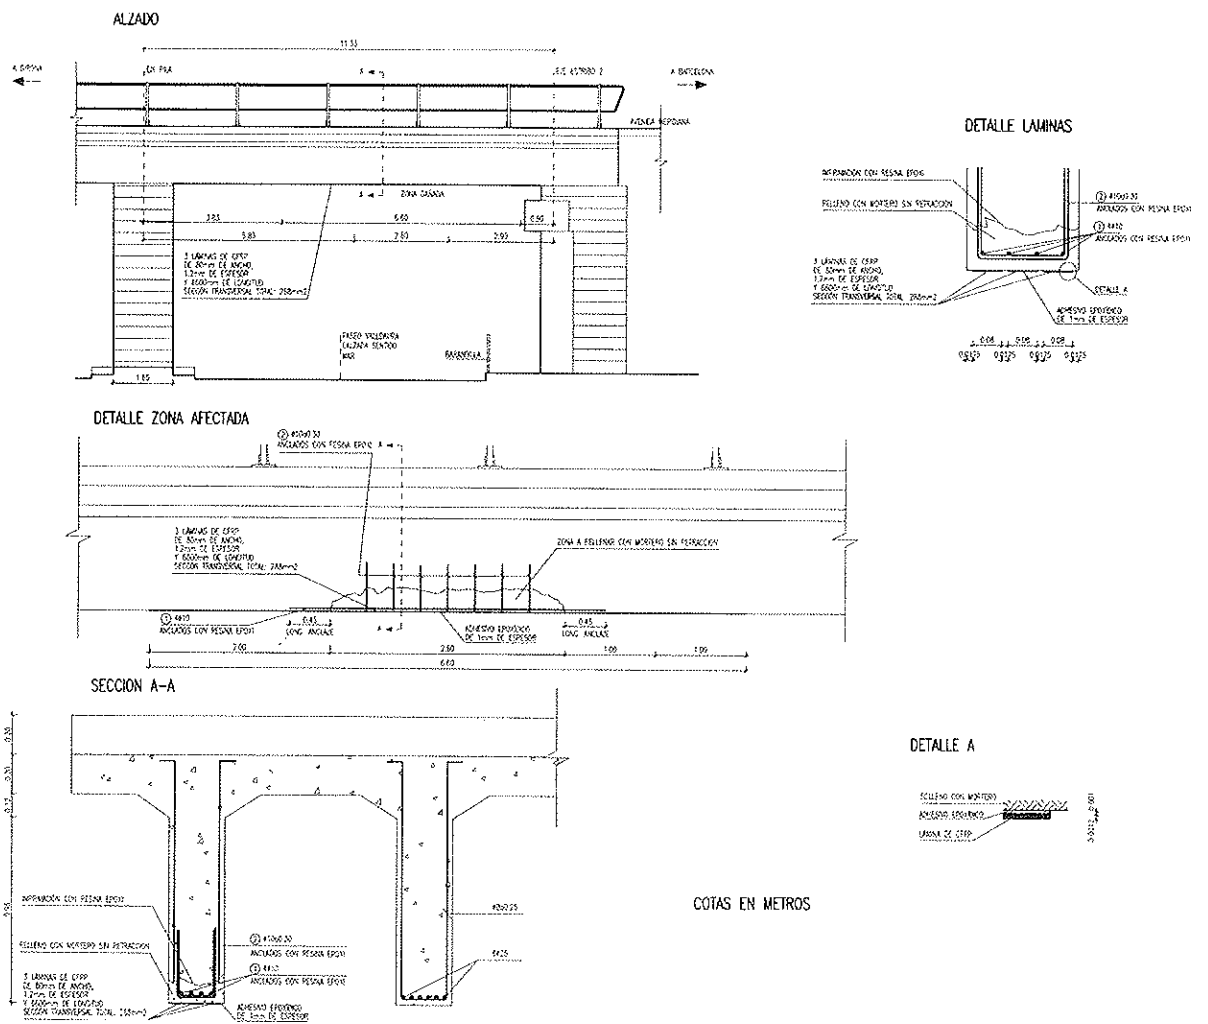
Reparación del puente del Dragó. Alzados y secciones.
